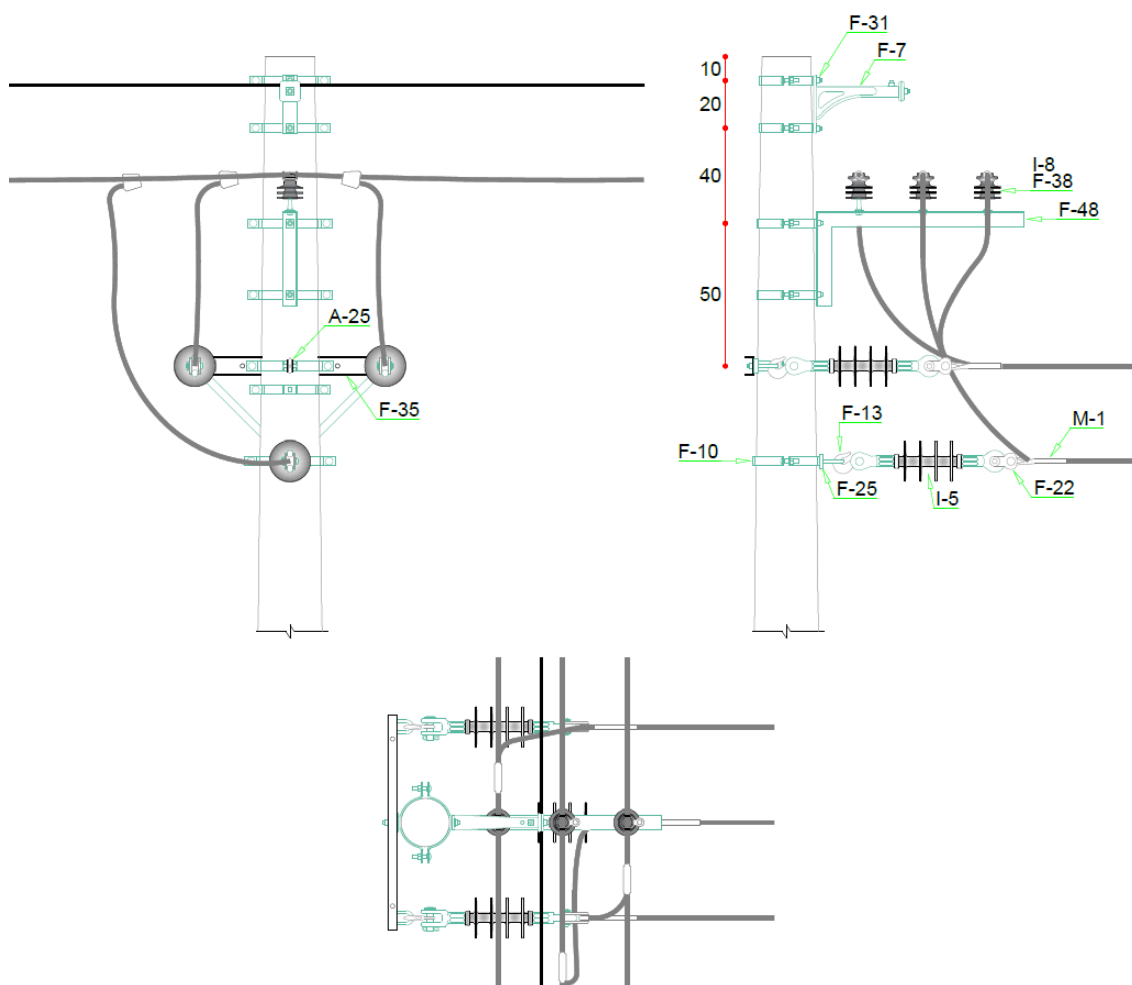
Estrutura CE2H-CE3U com suporte horizontal e perfil U
